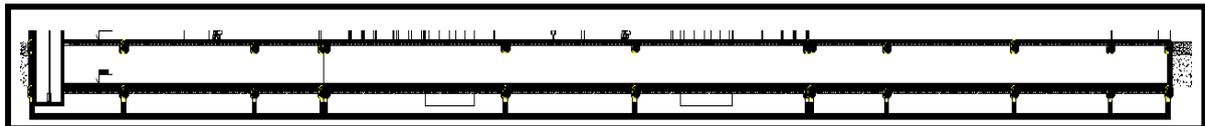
Coupe sur les fondations du projet / Source :Elaboré par l'auteur
